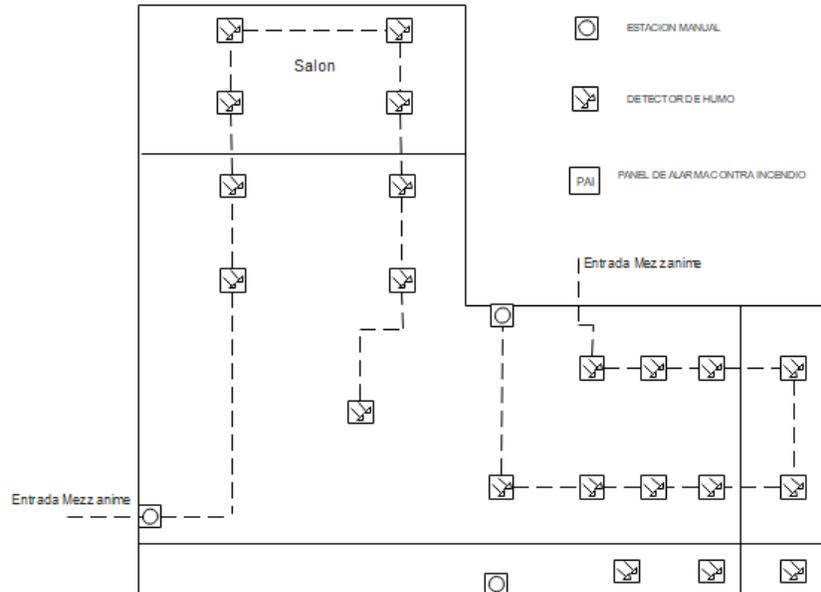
Plano mezzanine sexto piso inicial. [Autor]
